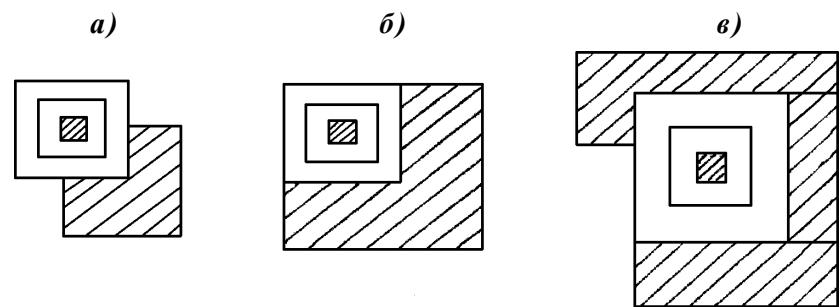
, б. Способы вскрытия столбчатых фундаментов:
